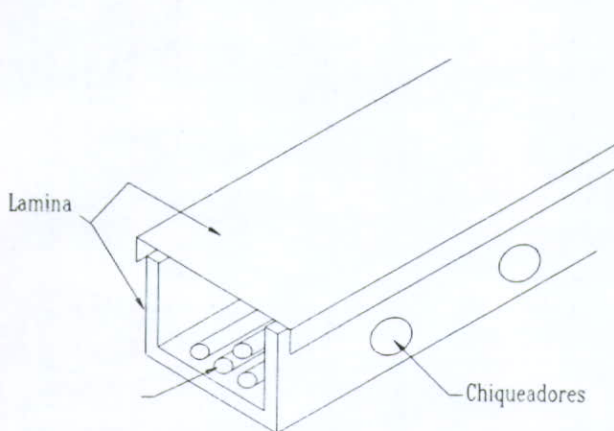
Ducto. Ducto cuadrado de lamina para cables aislados.
